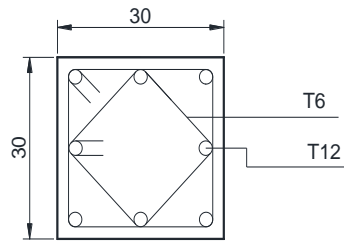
Ferrailage d'un poteau 30x30cm (poutres normales - plan irrégulier en élévation)
